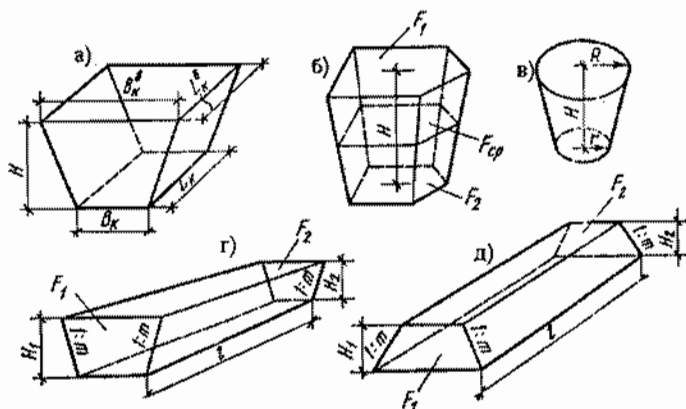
Схема для определения объемов земляных работ при устройстве котлованов различной формы, траншей и насыпей: а, б, в - котлованы прямоугольные, многоугольные и круглые; г - траншея с откосами; д - насыпь
